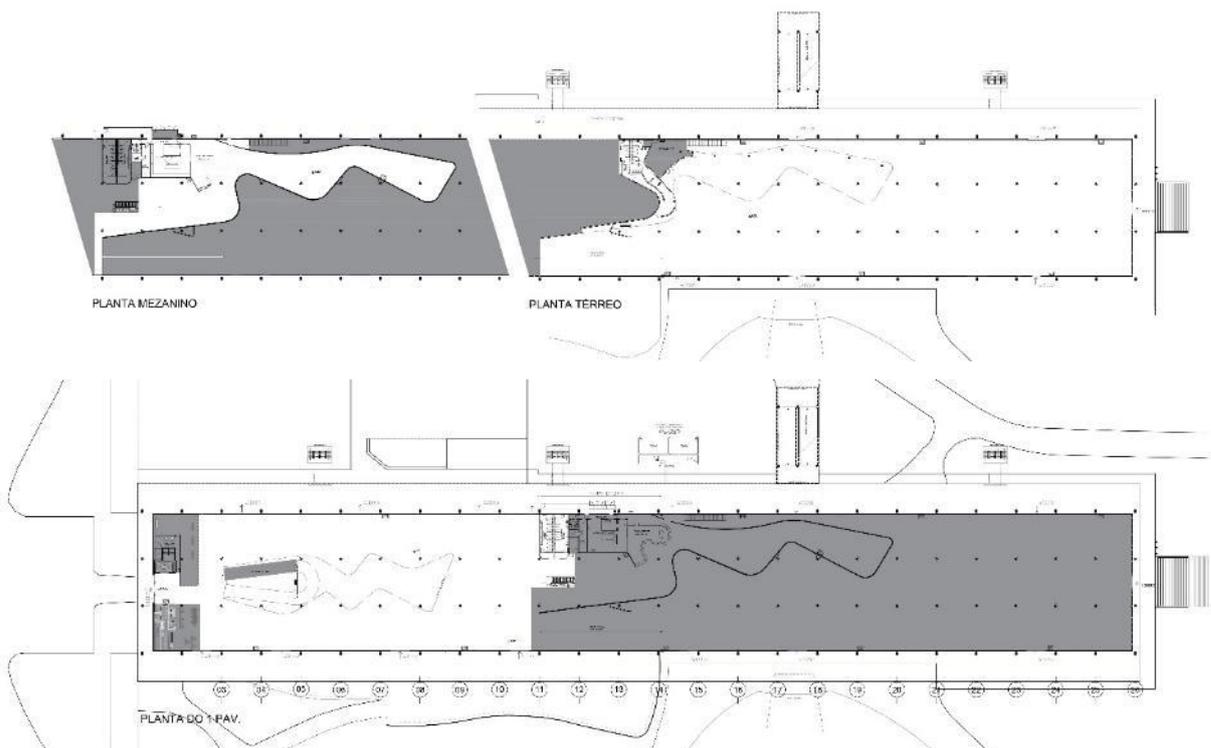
Plantas do térreo, mezanino e primeiro pavimentos do Pavilhão Bienal | São Paulo
